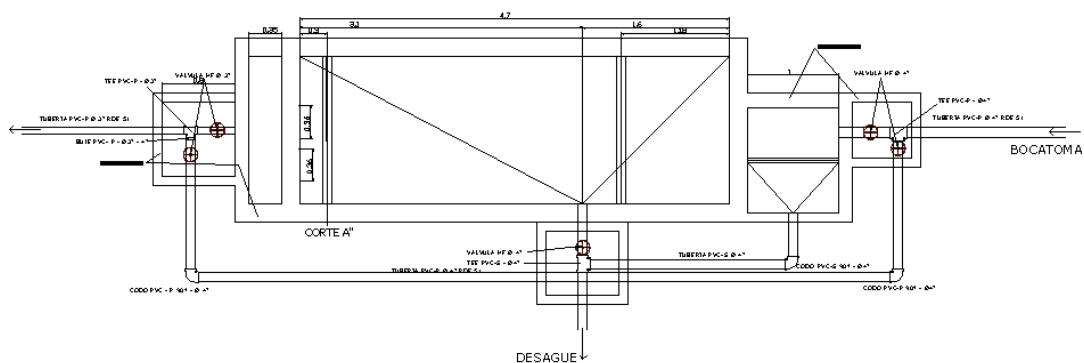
Desarenador – Planta (López Cualla, 1995)
